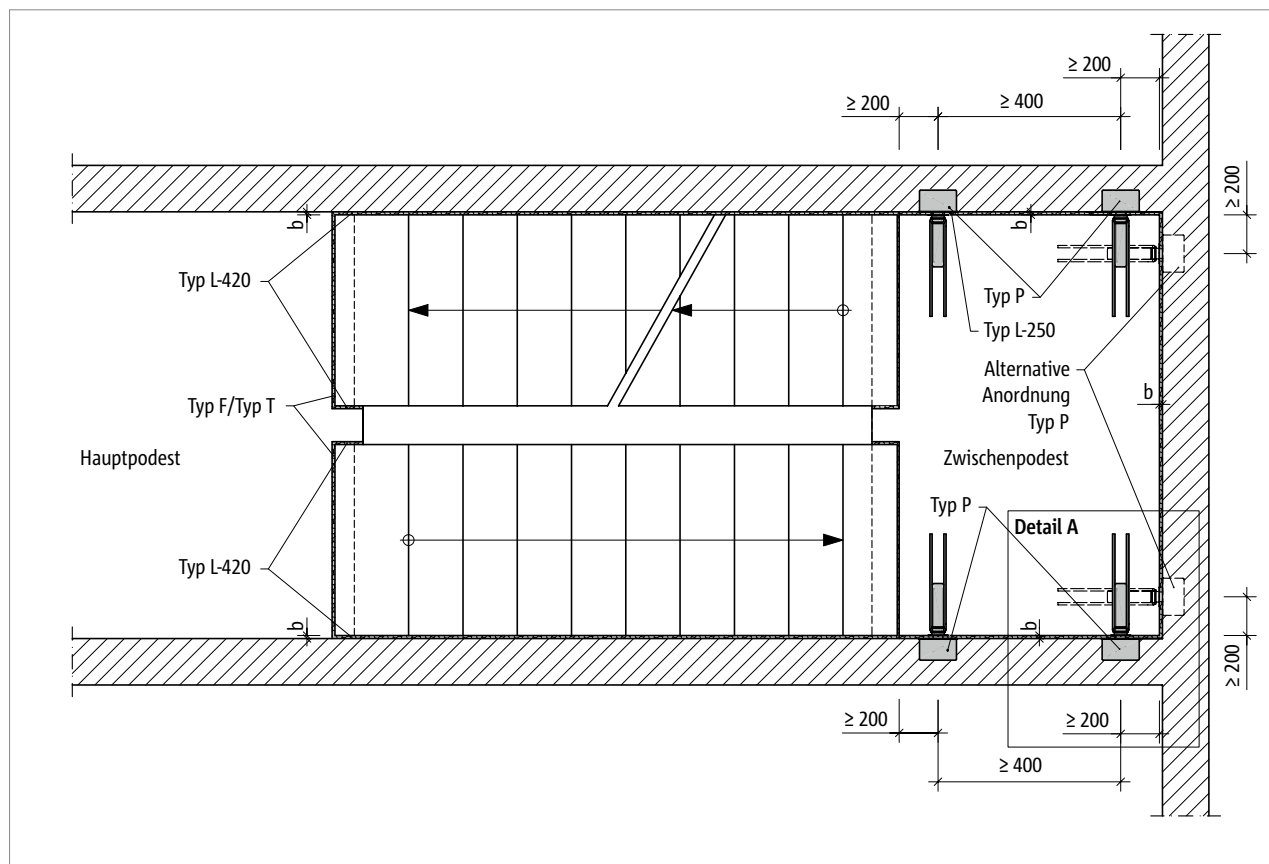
Tronsole® P: Elementanordnung im Grundriss mit Verwendung der Tronsole® L
